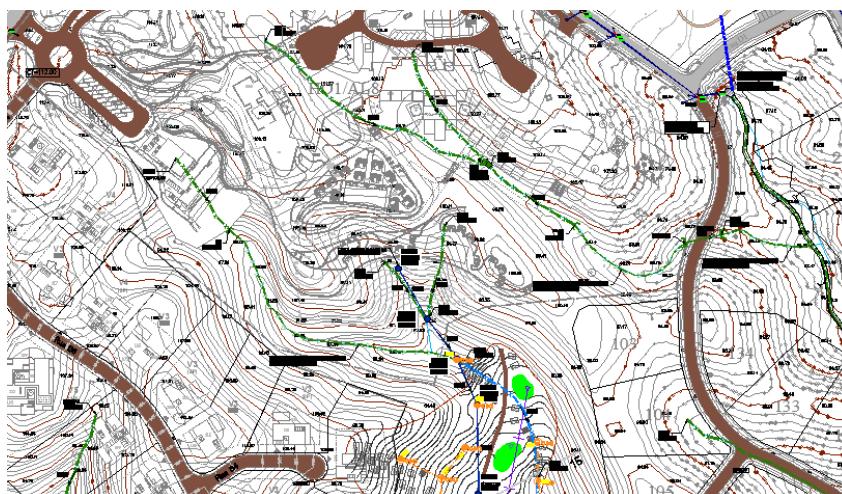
Representação a verde as Infraestruturas a prever em fase de construção dos Lotes e a rede a azul, a rede de drenagem a construir antes da modelação do campo de Golfe, de forma a garantir a recolhas das futuras drenagens.
